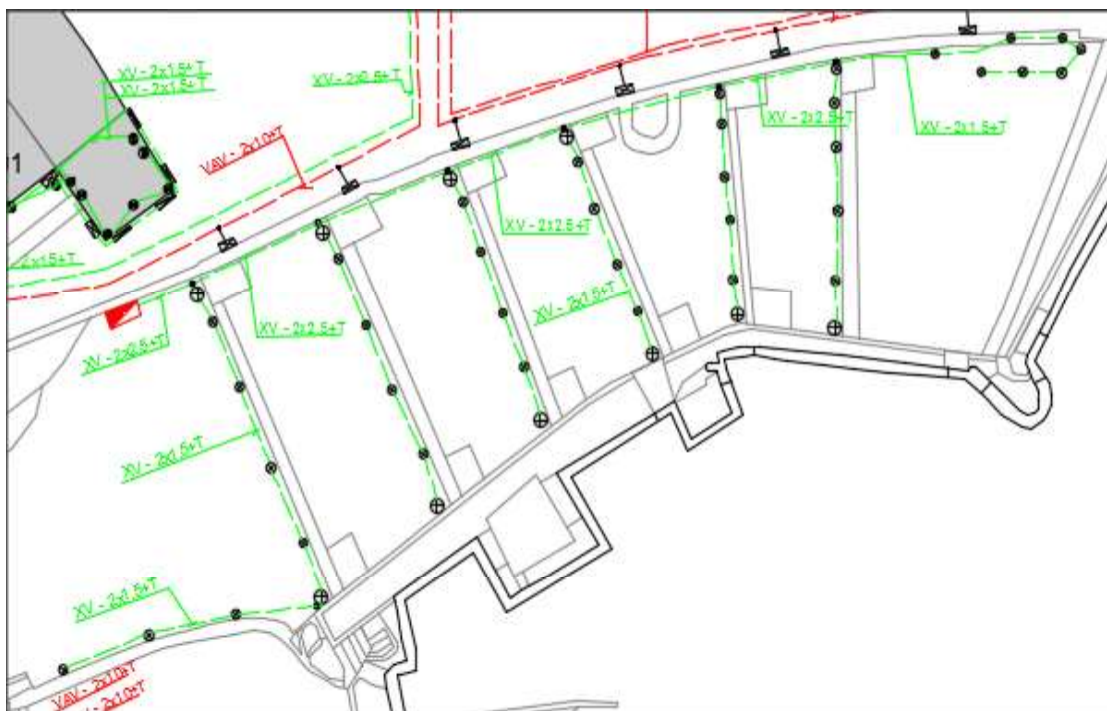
Ilustração das canalizações do ramal do Anfiteatro (Autocad 2016)
